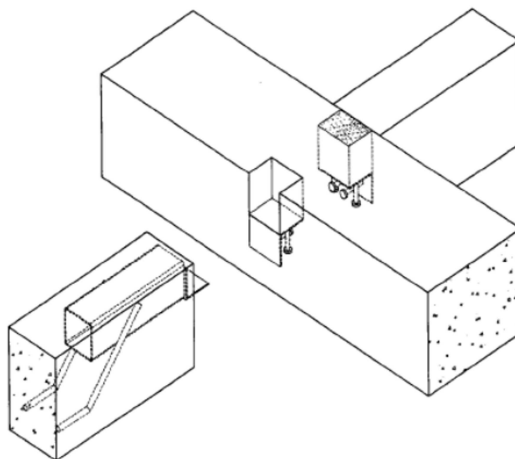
Exemplo de ligação viga-viga com armaduras em gancho. Adaptado de [1].
